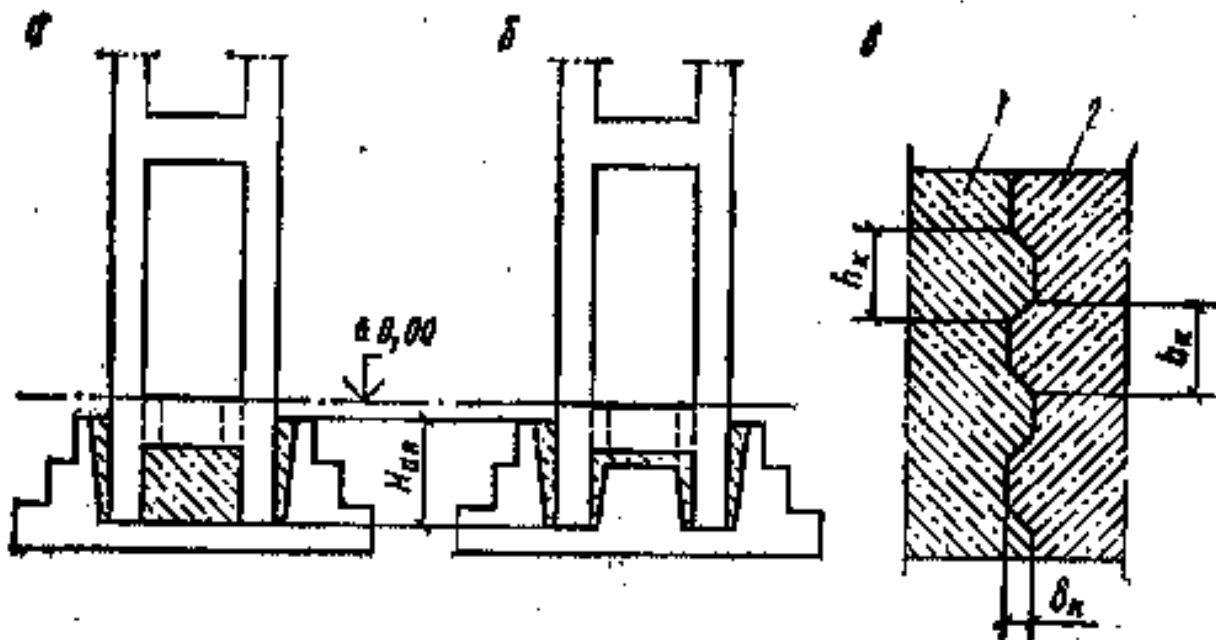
Конструкции соединения двухветвевой колонны с фундаментом:
